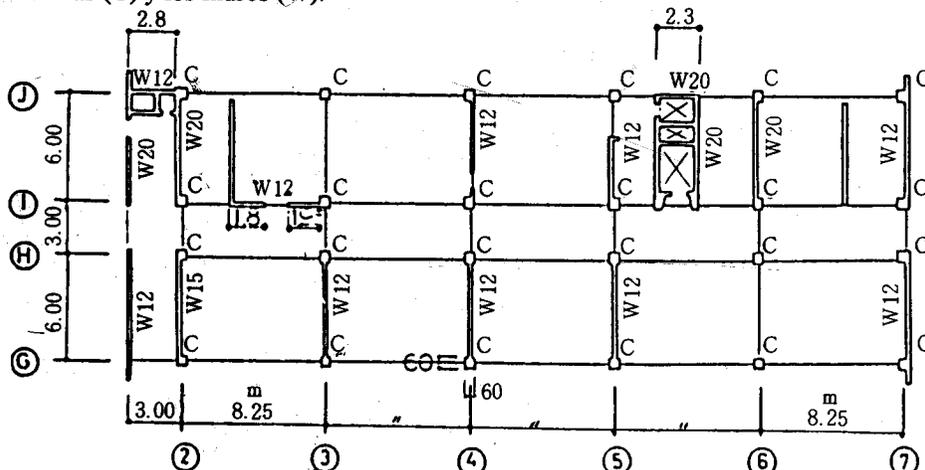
Colocación de las columnas y los muros en el tercer nivel
